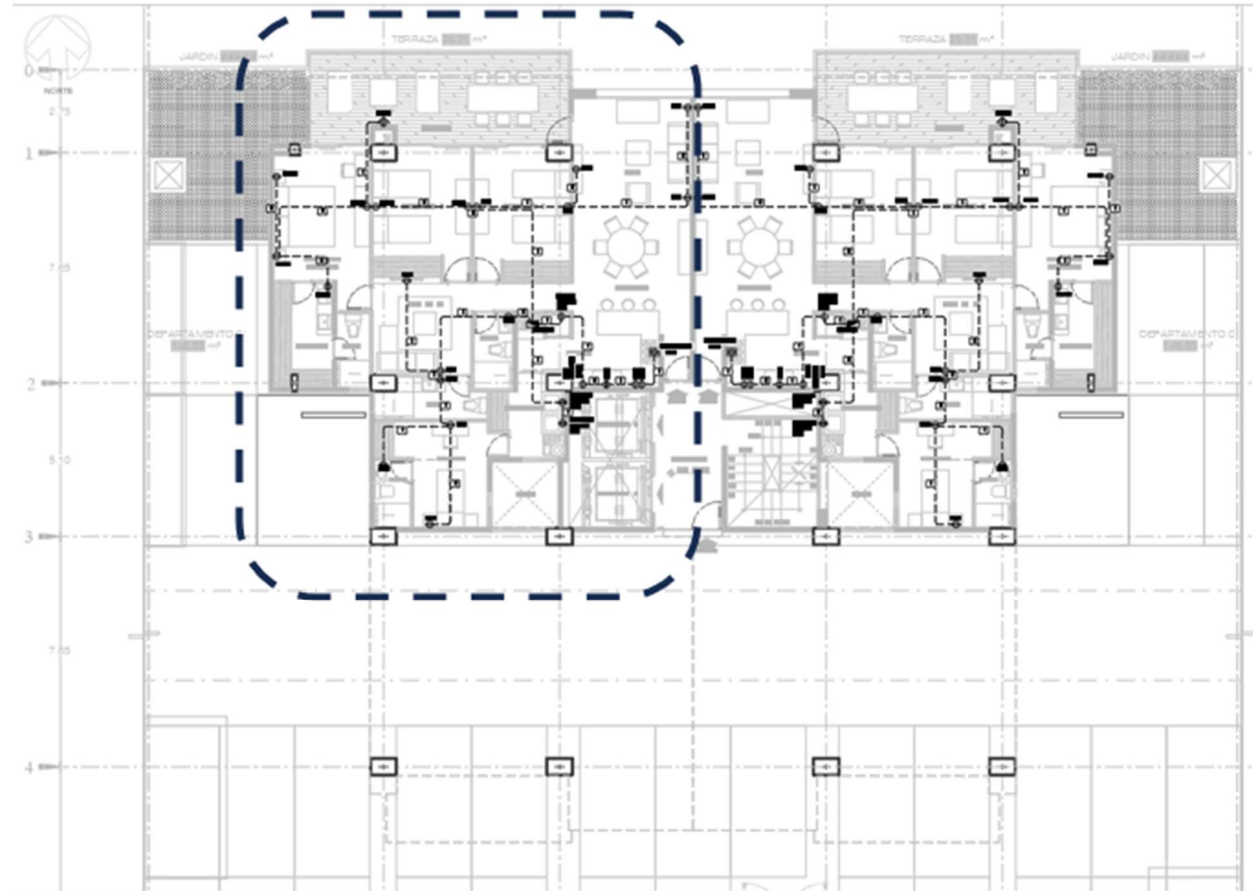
Instalación eléctrica Planta baja (Contactos)
